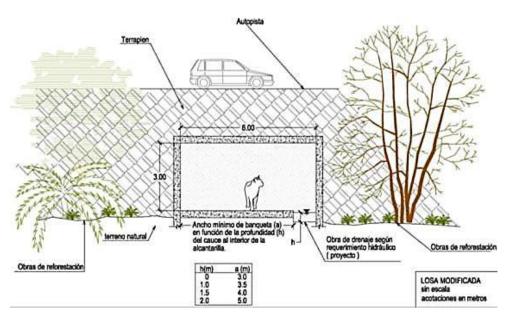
Esquema de losa plana sugerida para el proyecto. Ref. 18
